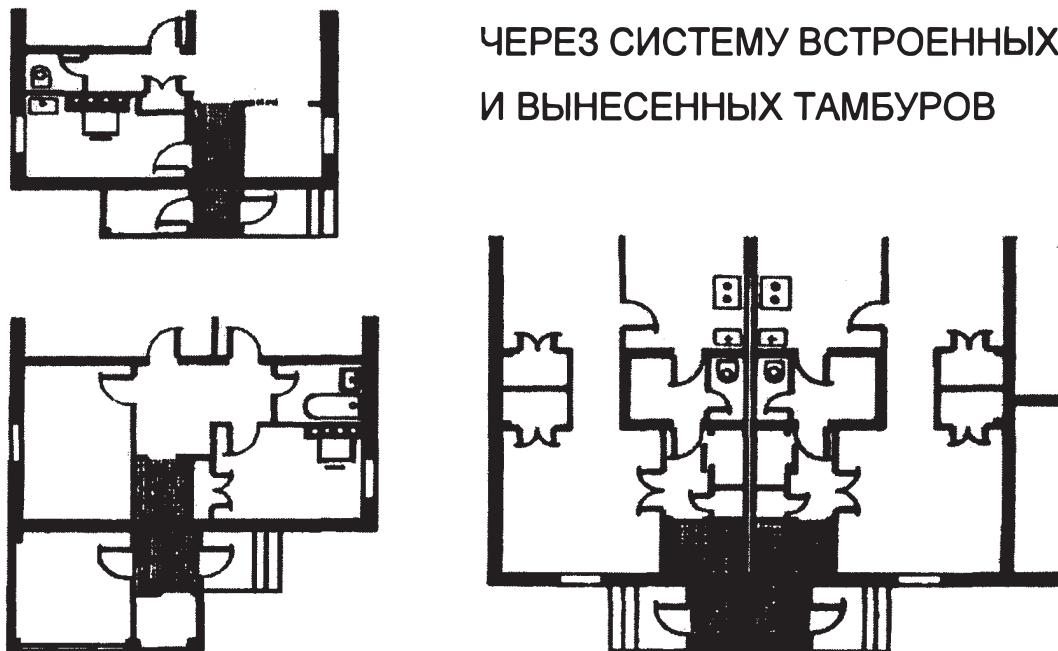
Планировочные схемы входных узлов малоэтажных жилых зданий
